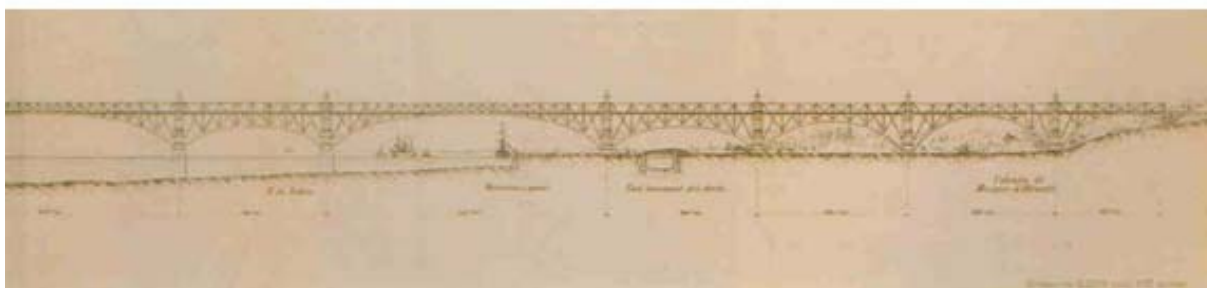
Traçado e alçado da ponte sobre o Tejo proposta em 1889 por Bartissol e Seyring
